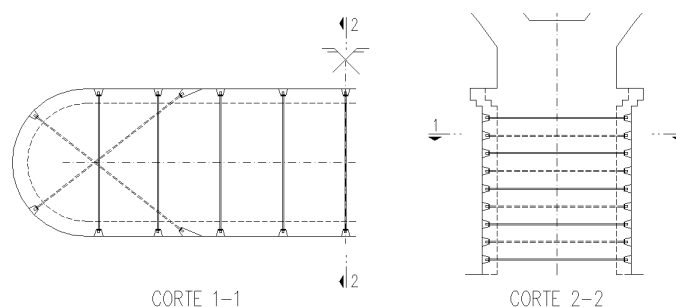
Reforço dos pilares – Solução alternativa adoptada
